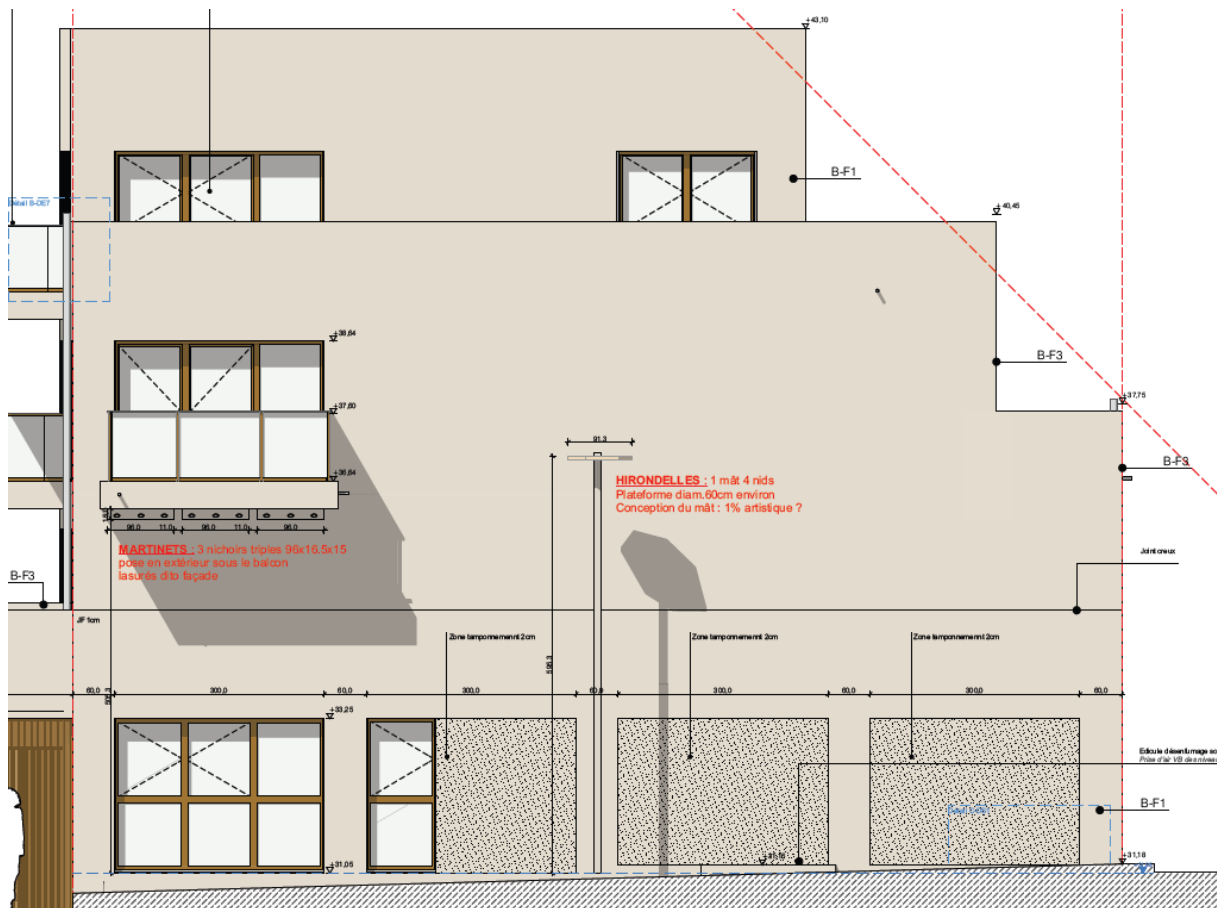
Zoom sur la localisation des nichoirs triples à martinet et du mat à hirondelles au sein de la façade est de la tranche 1 - Atelier 56S
